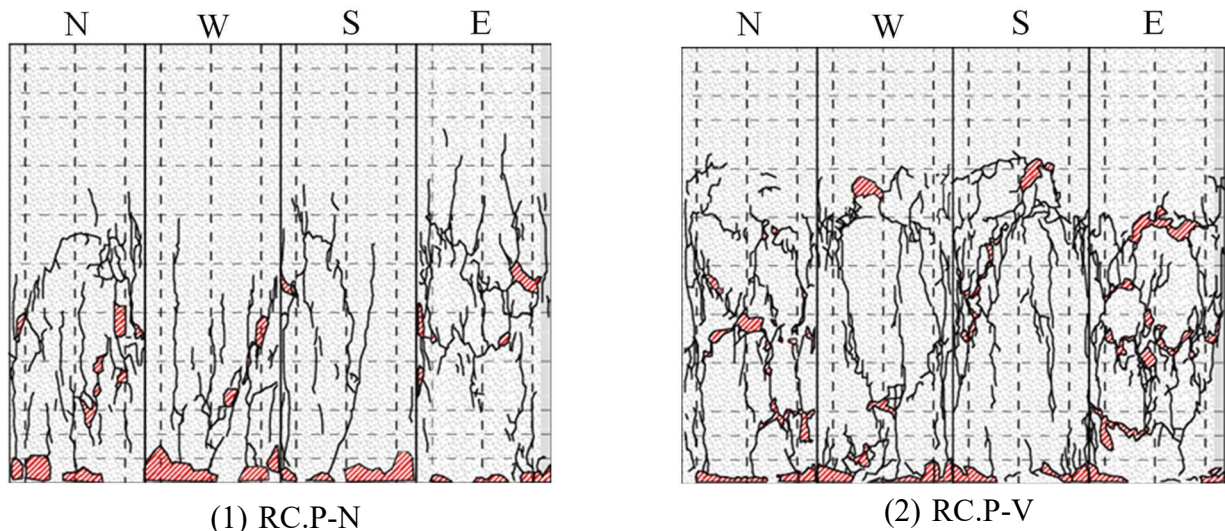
ひび割れ状況(補強前 RC 柱)
